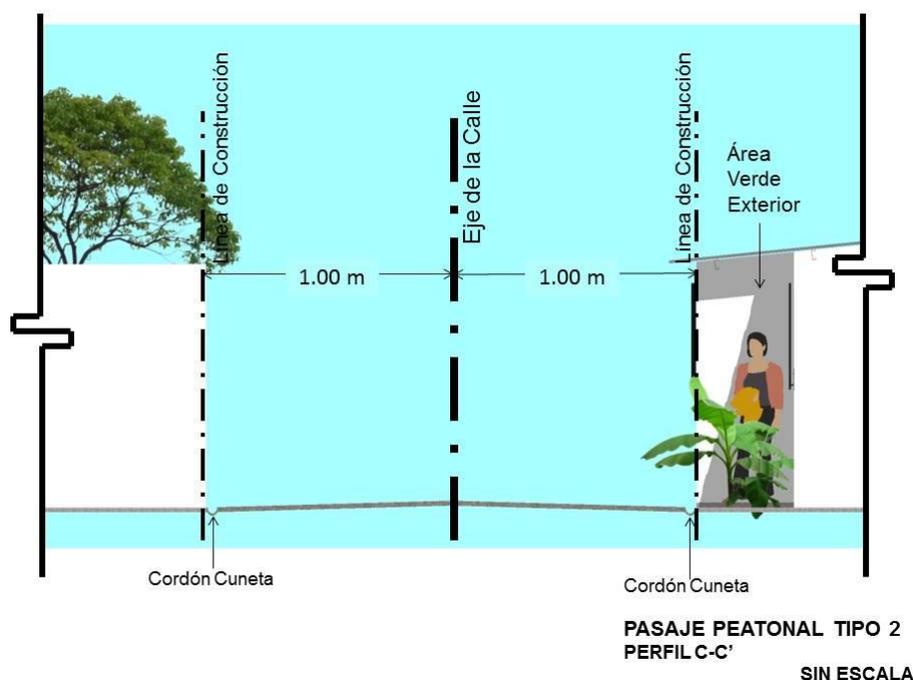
Perfil C-C' Pasaje Peatonal Tipo 2
